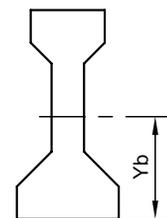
Poutres préfabriquées en béton précontraint de type AASHTO
